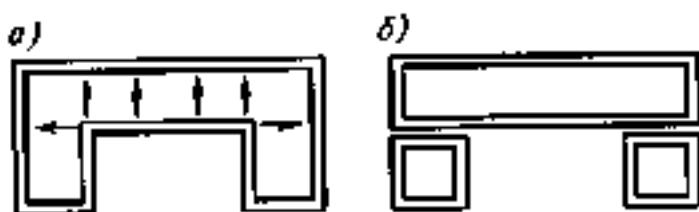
Схема разрезки здания со сложной конфигурацией в плане на самостоятельные отсеки:
